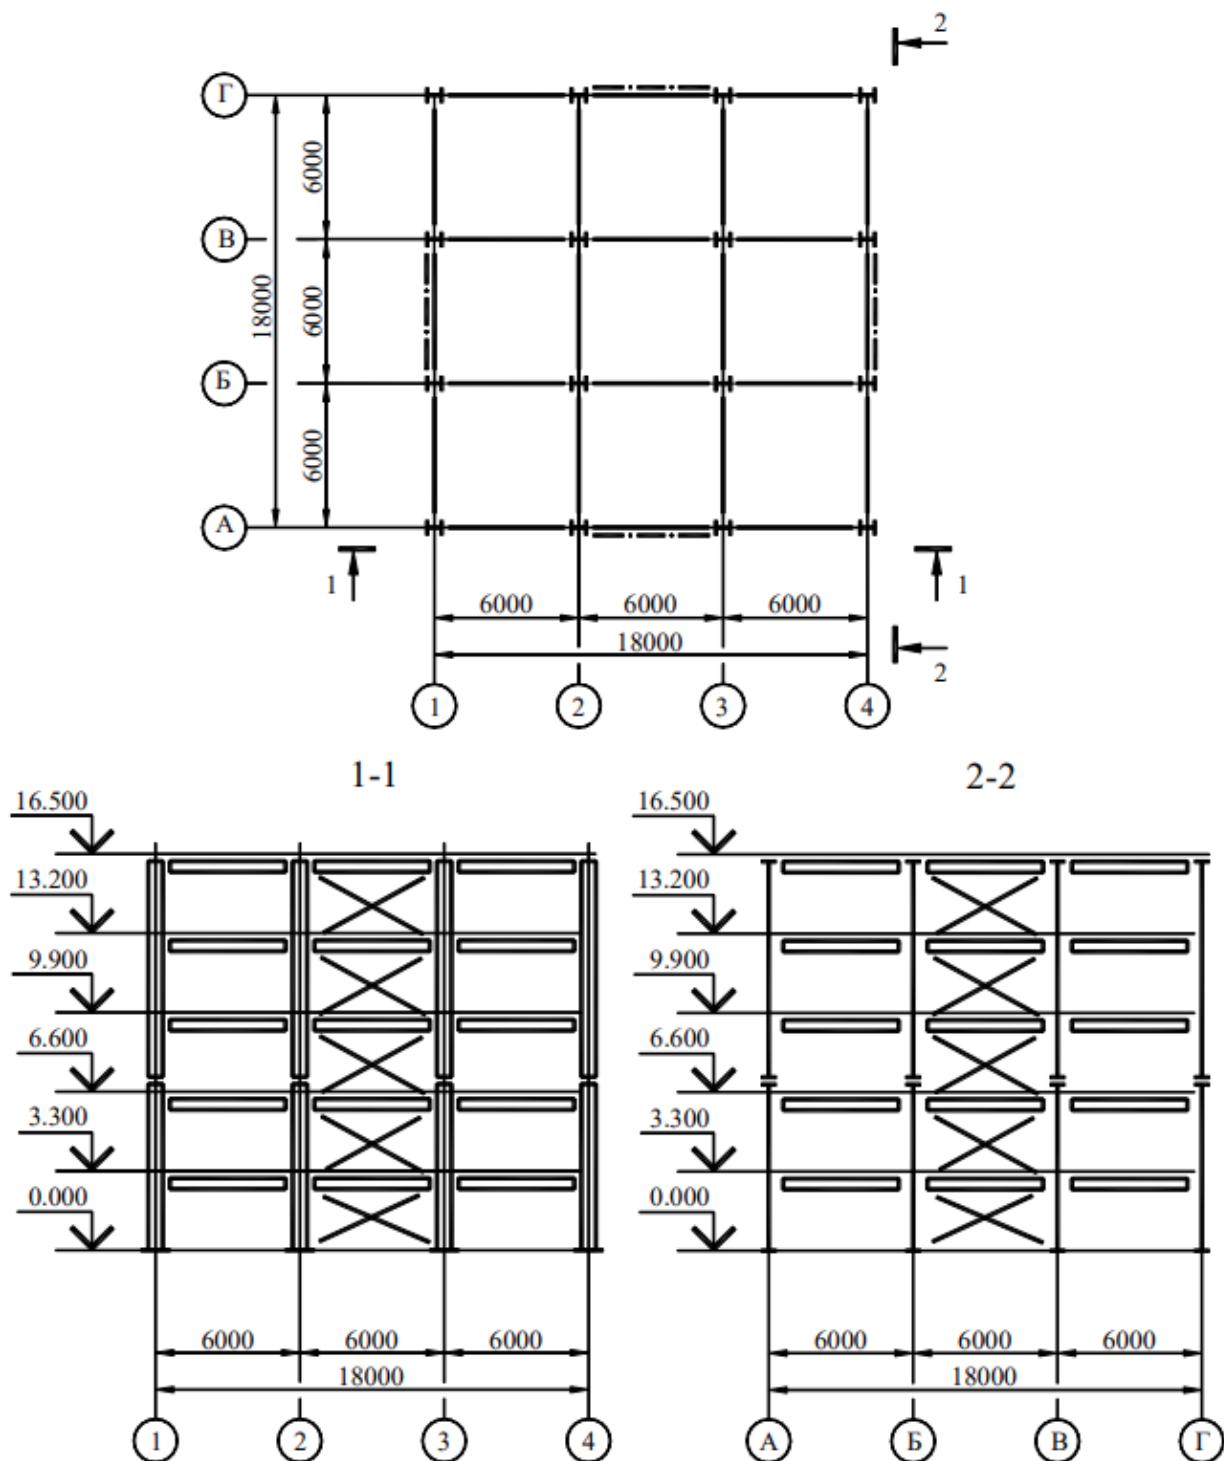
Схематический план и разрезы каркаса здания.
